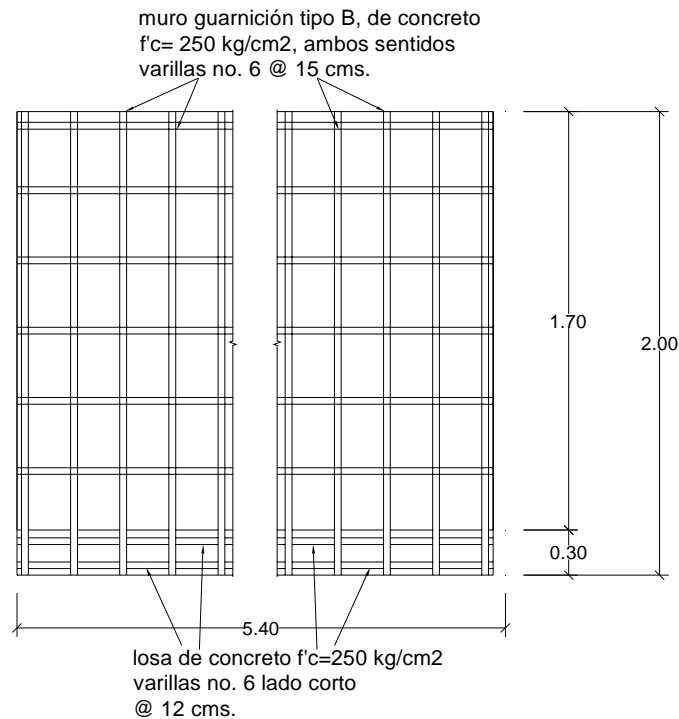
Alzado de muro contención tipo B con losa de alcantarilla
